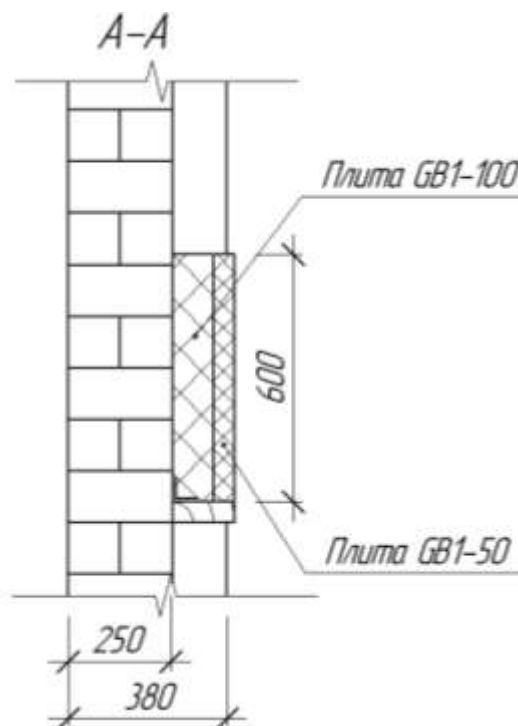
Монтаж утеплителя (стена в разрезе)
